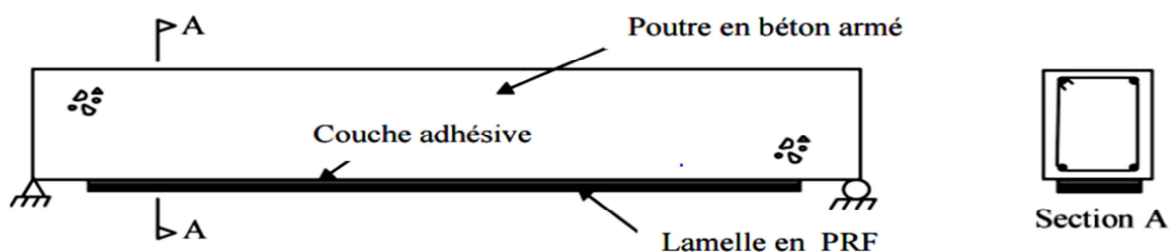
Une poutre en béton armé renforcée par une lamelle en PRF [36]
